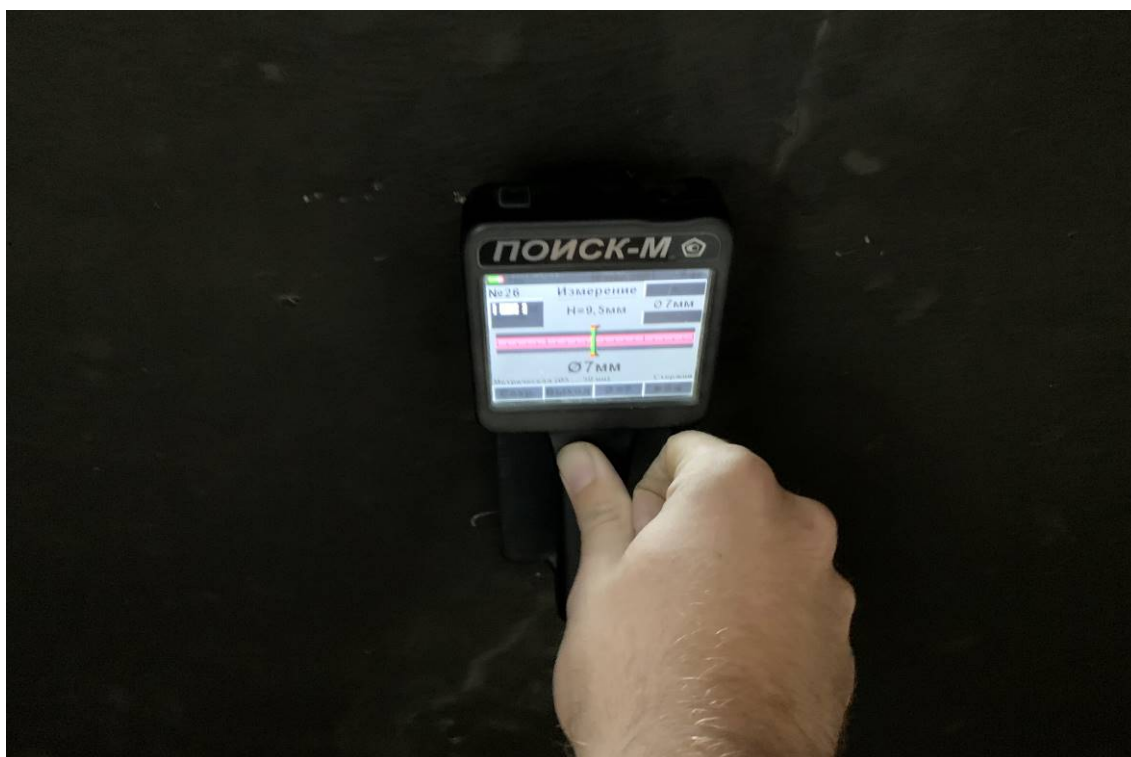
Определение положения арматурных стержней плит перекрытия с помощью ПОИСК-М
